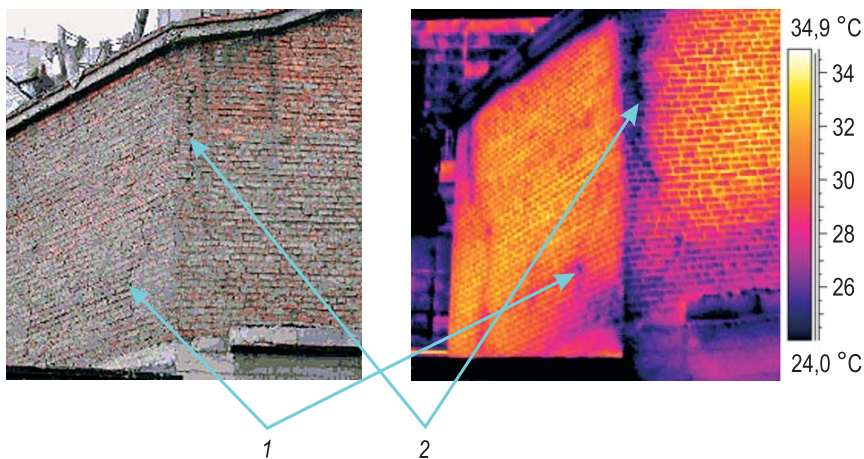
Тепловой контроль газоходов: 1 — внутренняя трещина; 2 — присос воздуха через трещину в кирпичной кладке (разрушение теплоизоляции внутри газохода)
